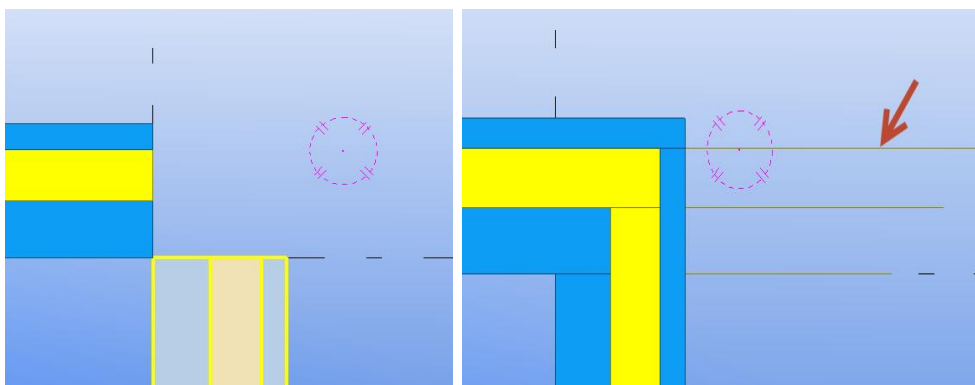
Aukon alareunan säätö Sandwich wall window -komponentissa
